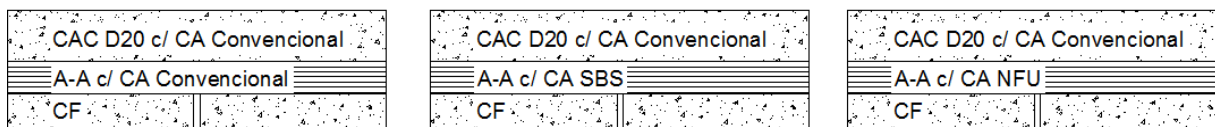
esquema de modelo 1. CAC D20: concreto asfáltico denso tmáx. 20 mm. A-A C: Arena asfalto. CA: cemento asfáltico. SBS: polímero virgen. NFU: neumático fuera de uso.
